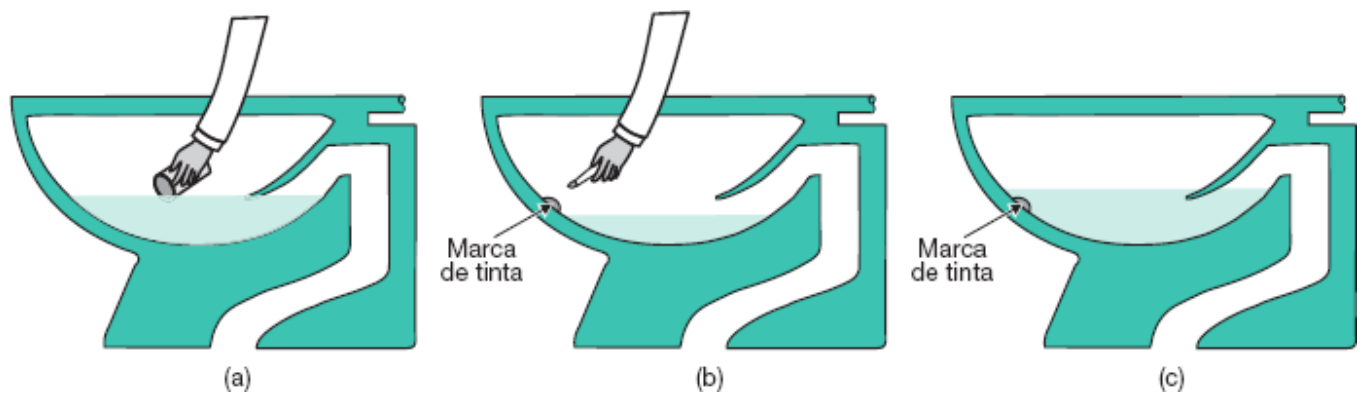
Teste de vazamento em aparelhos sanitários.
